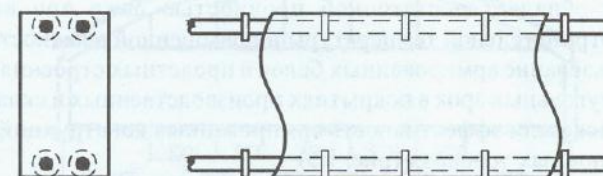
Конструкция армированной балки Х. Гранхольма
